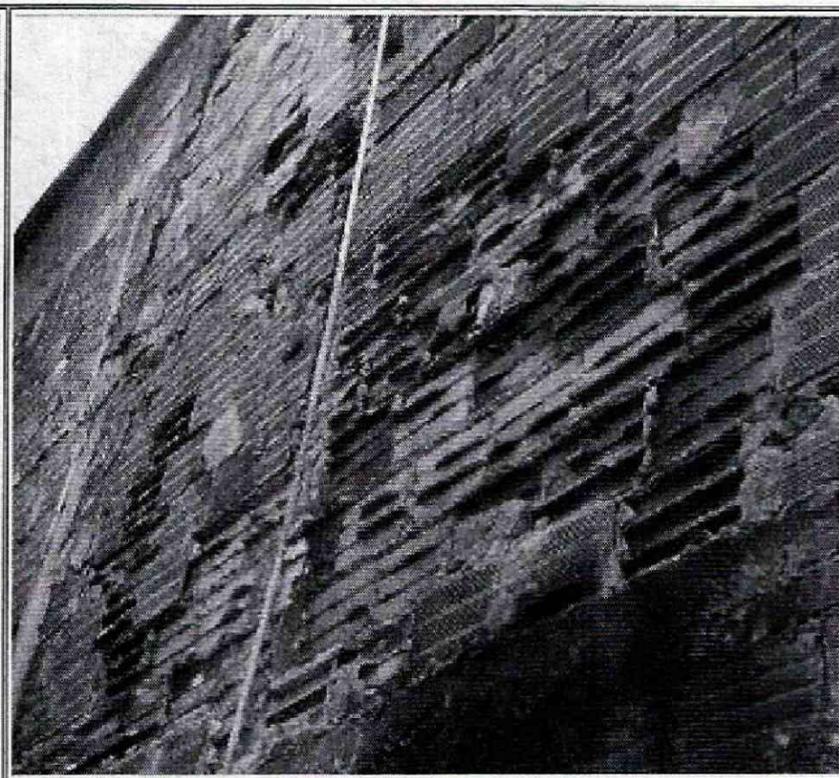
Vista exterior del muro de cerramiento perimetral costado norte del predio de la Transversal 8 B Este No. 89 – 46 Sur
